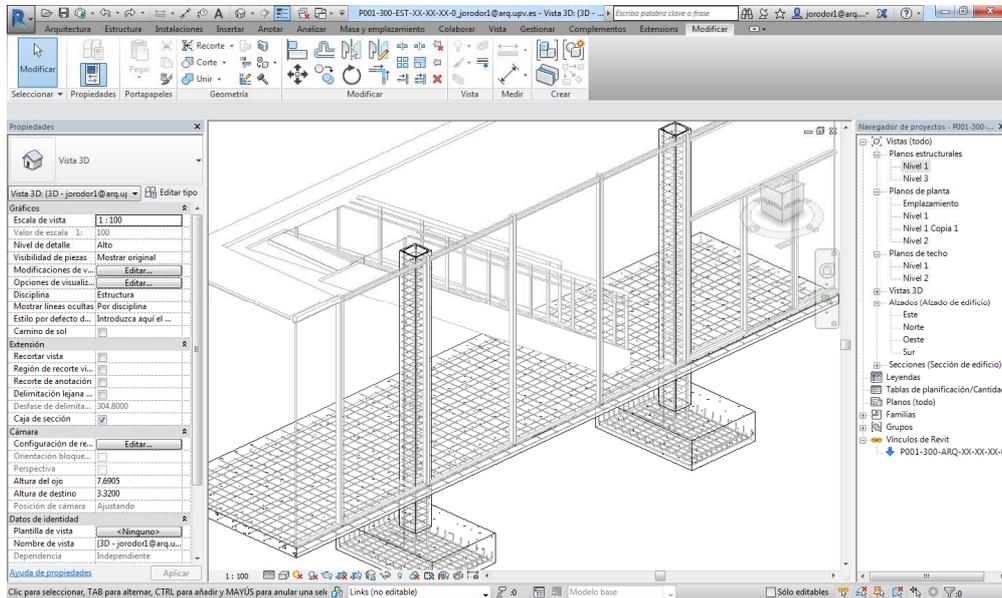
Detalle Armado estructural en Revit importado desde Robot
